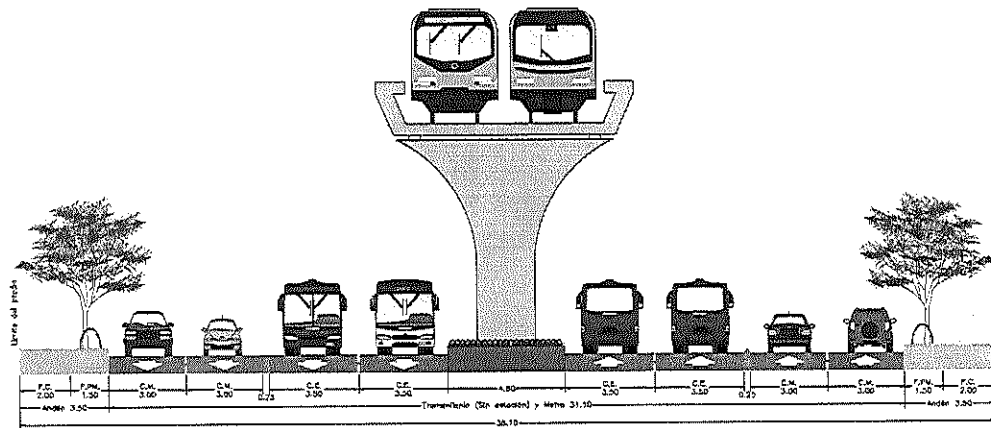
Sección transversal en la Calle 1 entre la Carrera 27 y la Avenida Caracas
